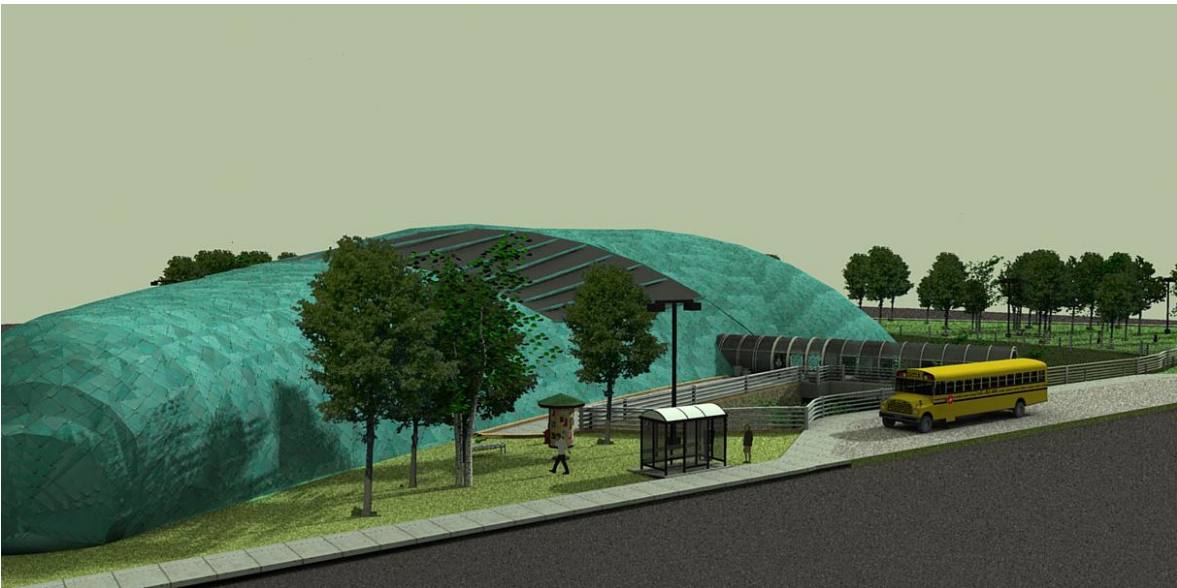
Vista de la fachada norte, el acceso principal por medio del puente. 89
